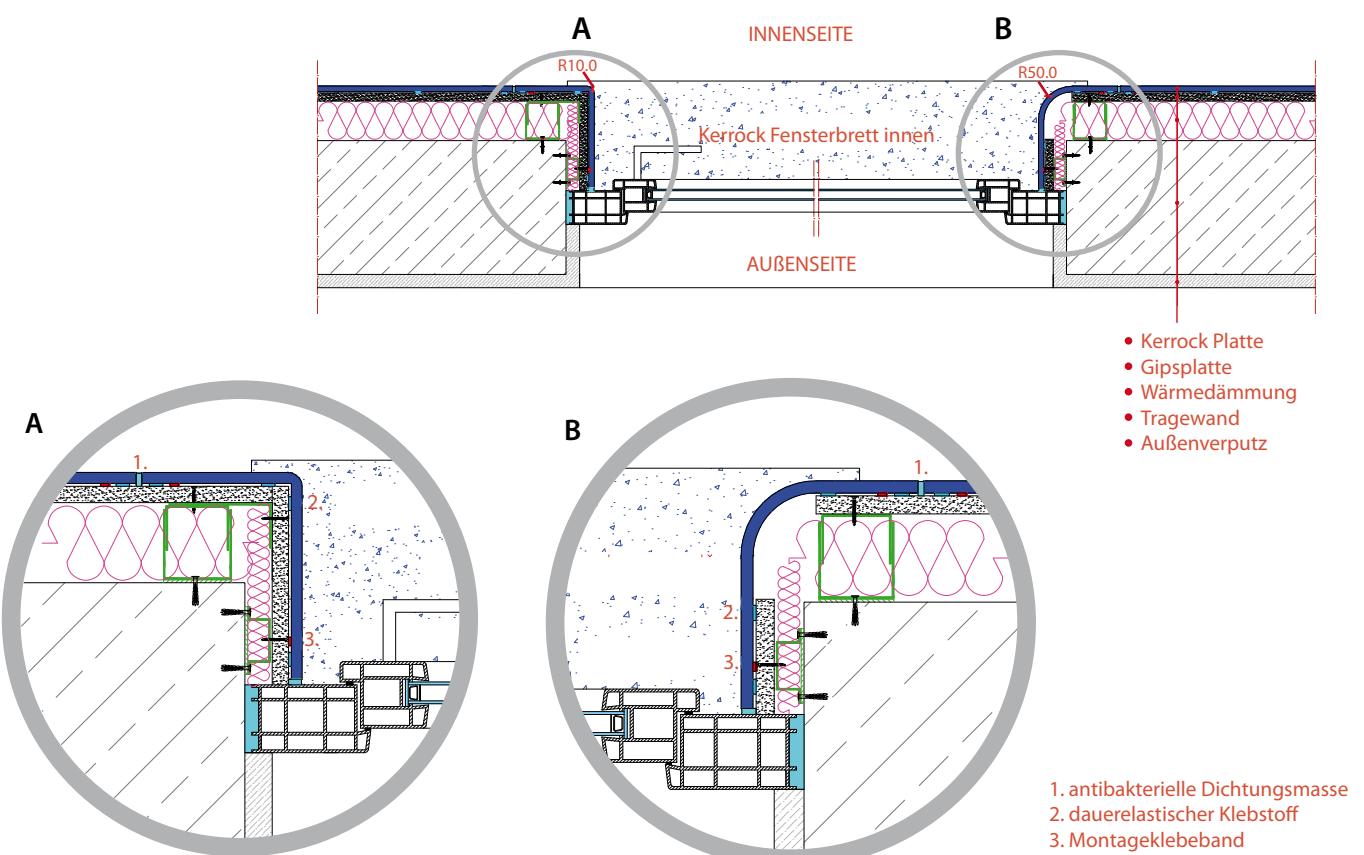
Grundriss Kerrock Verkleidung – Gipsplatte – Tragwand.
